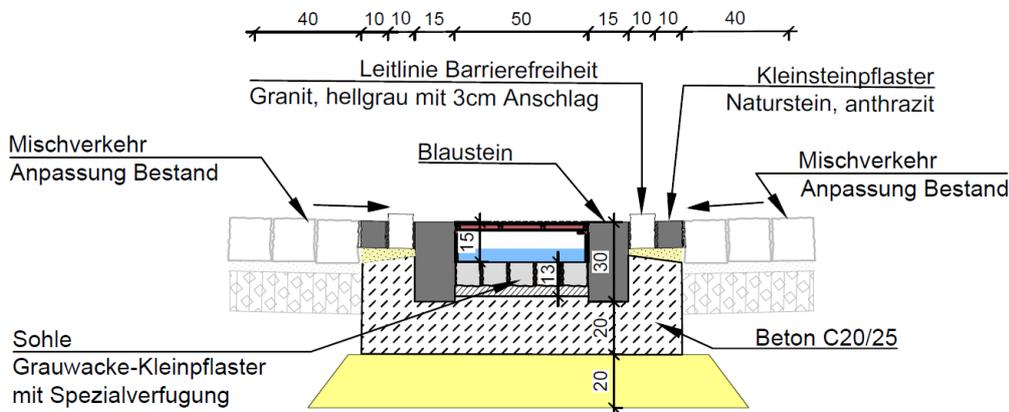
Schnitt 2-2 durch offene Gerinneführung in Mischverkehrsstraße (Schmiedstraße, obere Kleinmarschierstraße) mit Abdeckung aus Gusseisen
